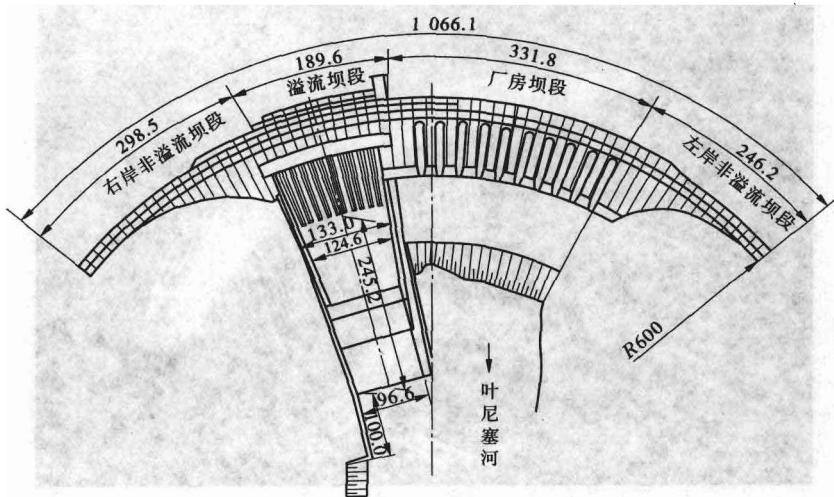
萨扬舒申斯克水电站平面布置 (单位:m)
